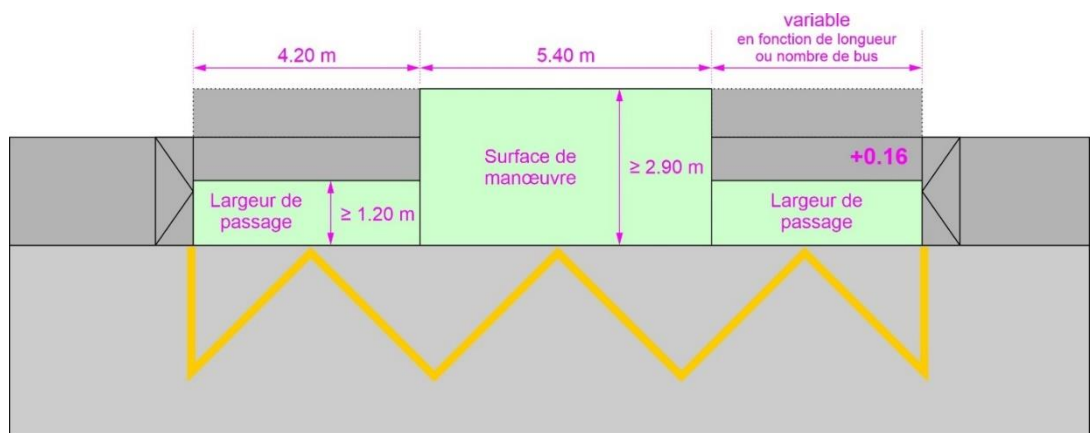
Dimensions de la situation en plan à respecter pour un accès avec différence de niveau et l'utilisation d'une rampe ou d'une plateforme élévatrice (bordure +16 cm)
